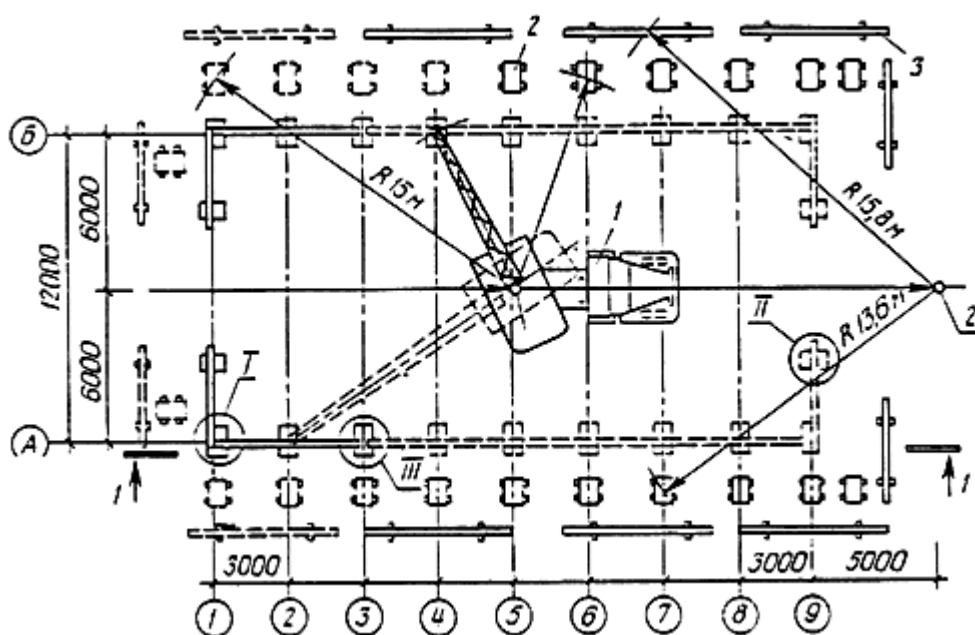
Схема монтажа фундамента. Узлы креплений:
